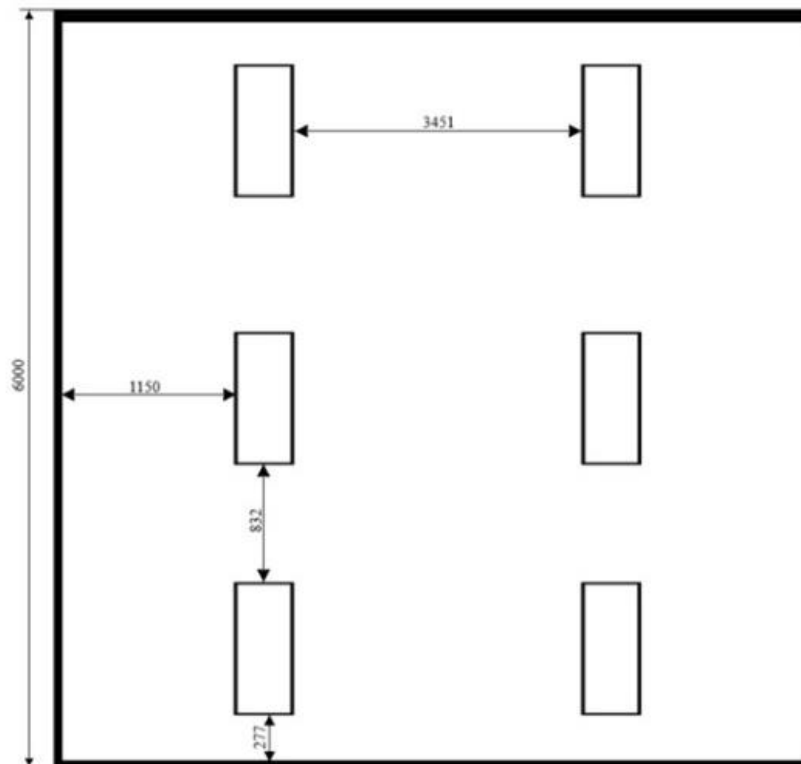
План помещения и размещения светильников со светодиодными лентами
